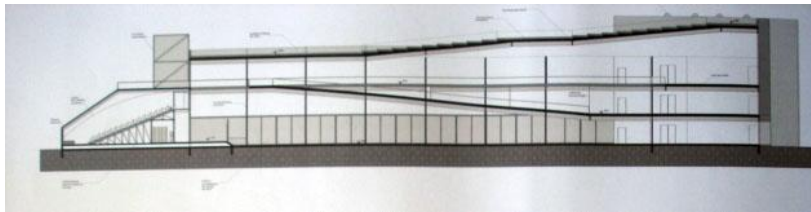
Pavilhão de Exposições. Corte Longitudinal. Aluno: Rafael Lorentz. 2007.
